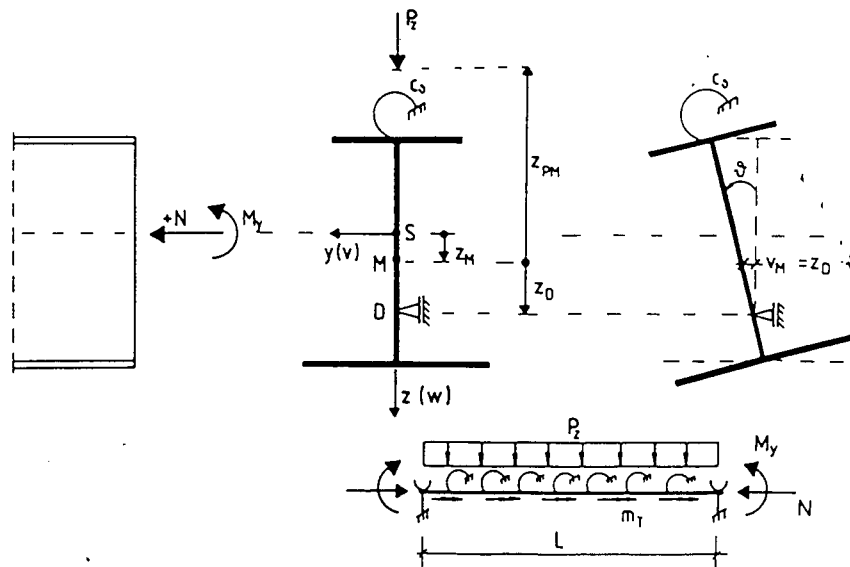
Stab mit gebundener Drehachse und drehelastischer Bettung,
